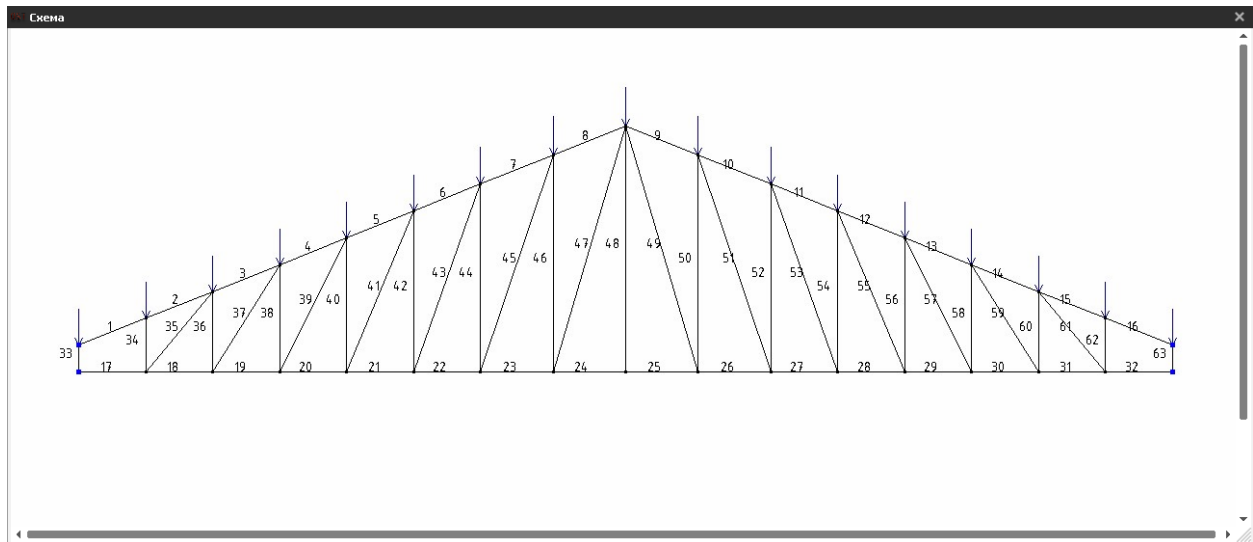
Увеличенная схема фермы (появляется по нажатию на схему)
